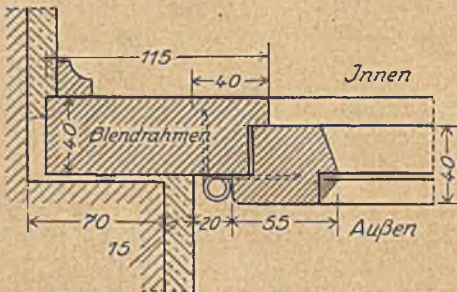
Nach außen schlagendes Fenster (Grundriß).
